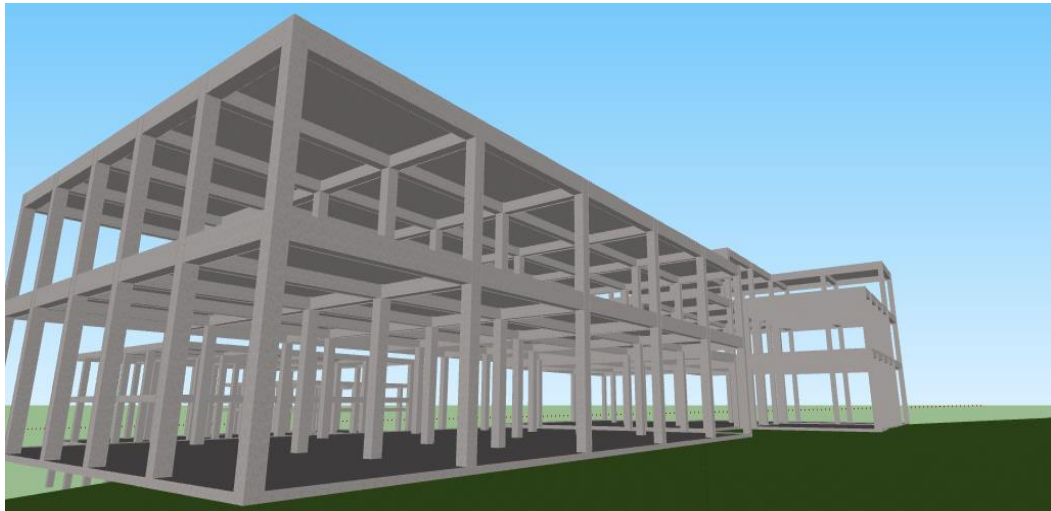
Structure béton armé poteau poutre de notre projet. Source : Auteurs.
